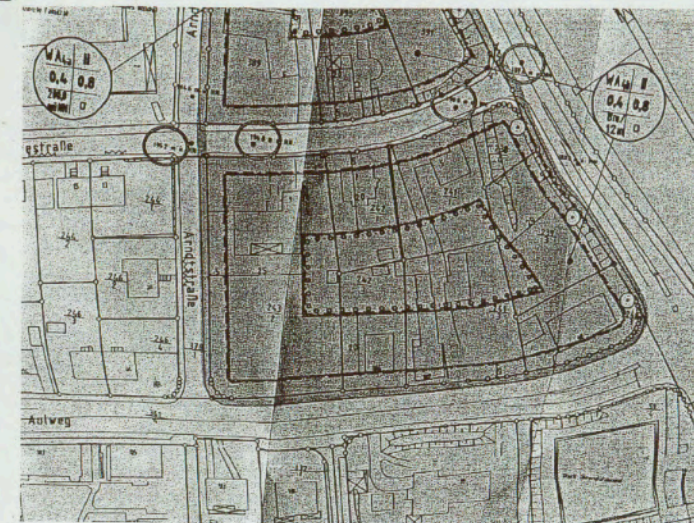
Rote Kreise: Höhenangaben entlang Fichtestr.
